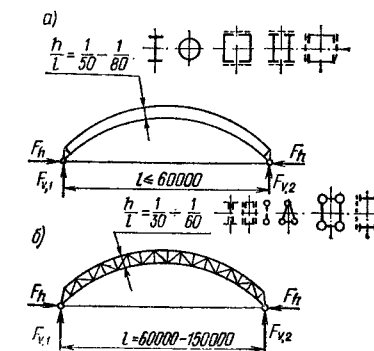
Конструктивные схемы и типы сечений двухшарнирных арок
